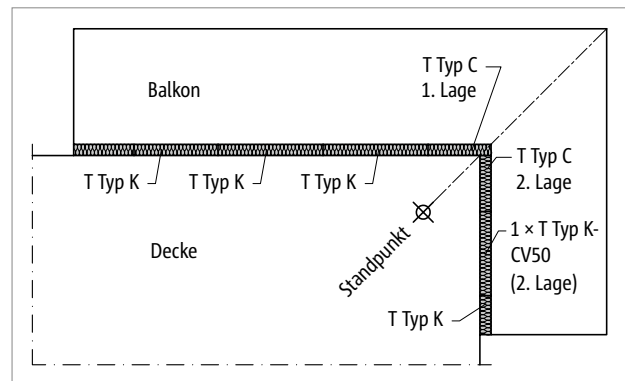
Schöck Isokorb® T Typ C: Balkon mit Außenecke frei auskragend
